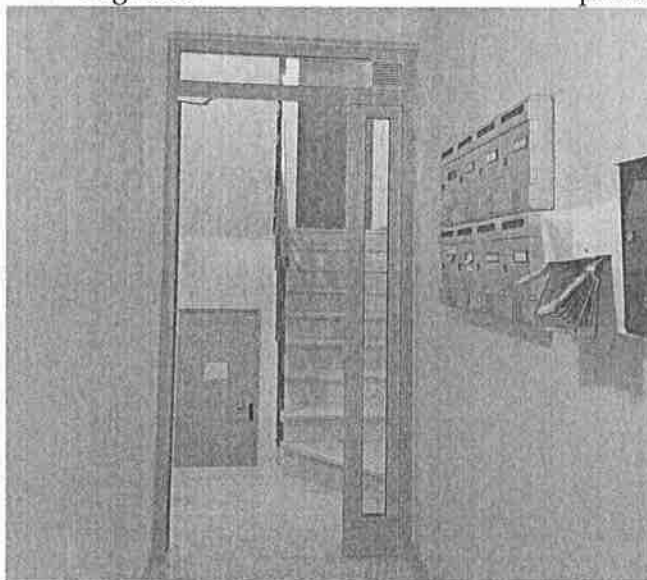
Ingresso al vano scala condominiale piano terra
